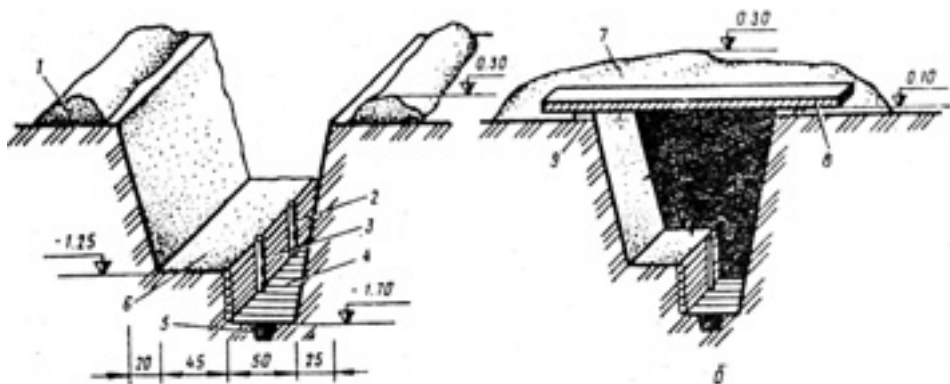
Щель без одежды крутоостей: а – открытая; б – с перекрытием из железобетонных плит; 1 – брусьев; 2 – стойка; 3 – забирка; 4 – настил пола; 5 – водоотводная канавка; 6 – скамья для укрываемых; 7 – насыпной грунт; 8 – плита; 9 – ненагруженная берма
